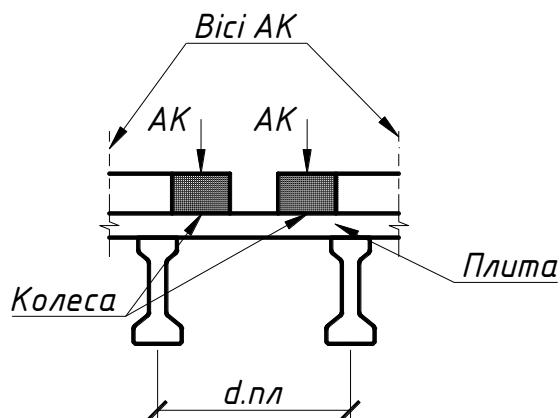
Схема завантаження плити двома смугами А-11.
